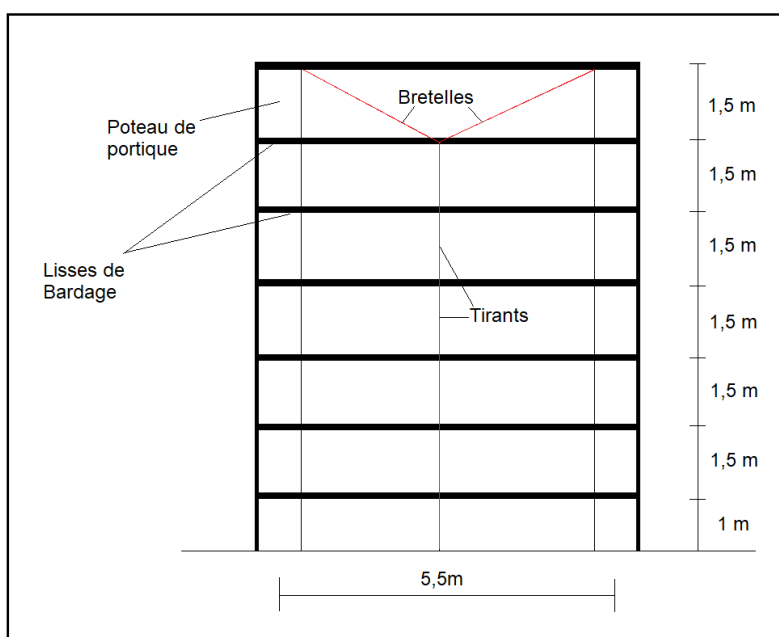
Coupe longitudinale sur les lisses de bardage.
